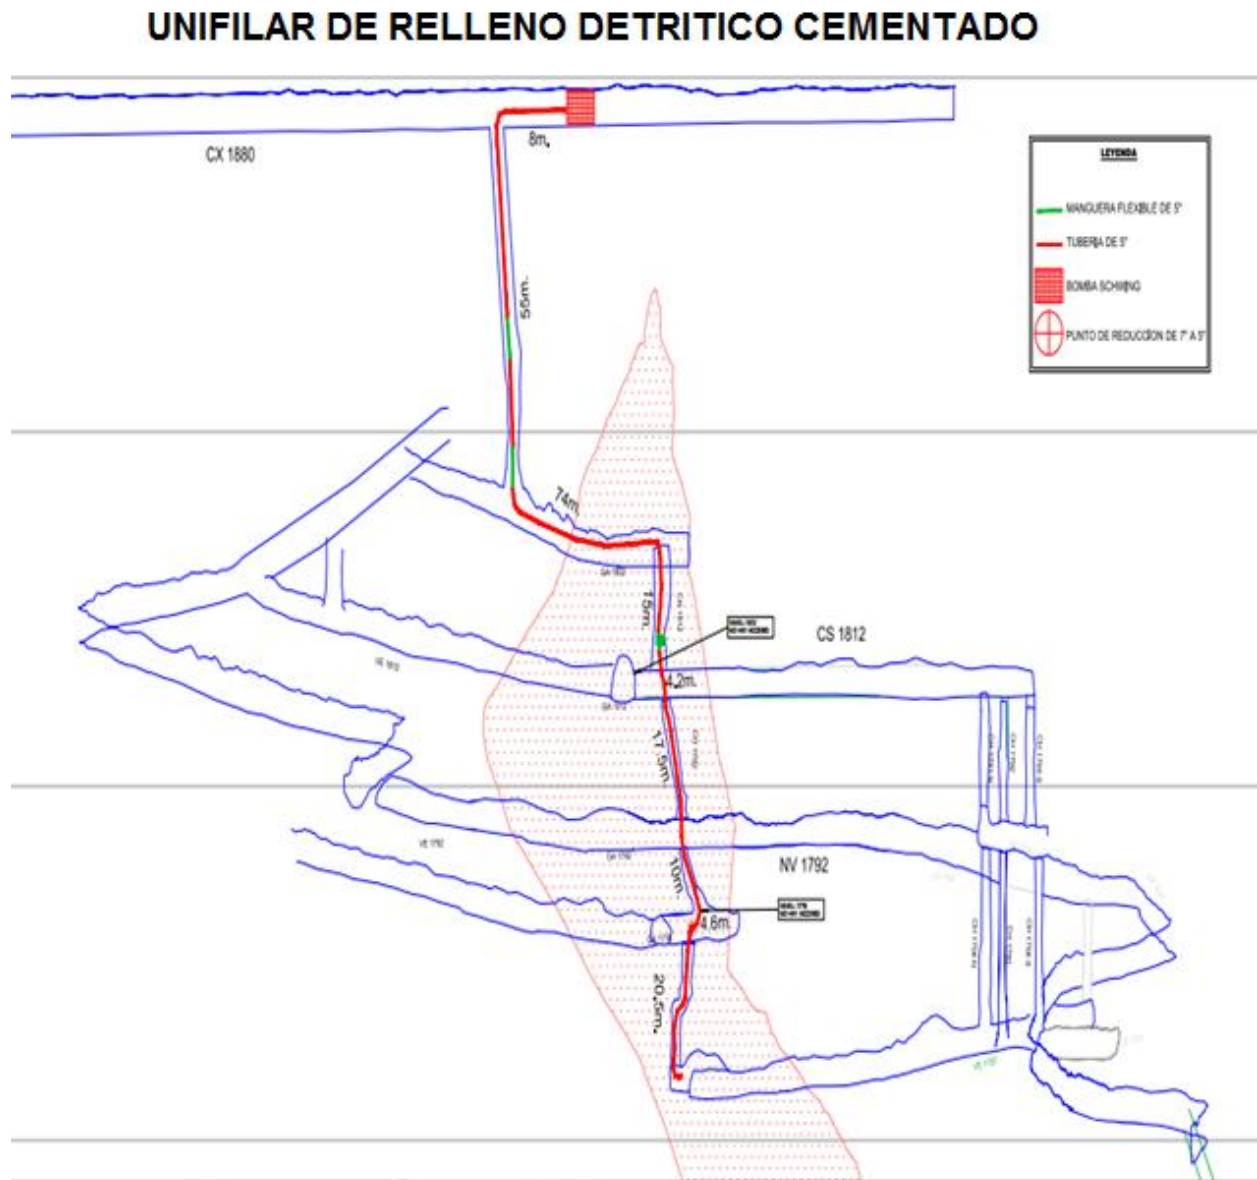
Recorrido del RDC de planta a la bomba SCHIWING
